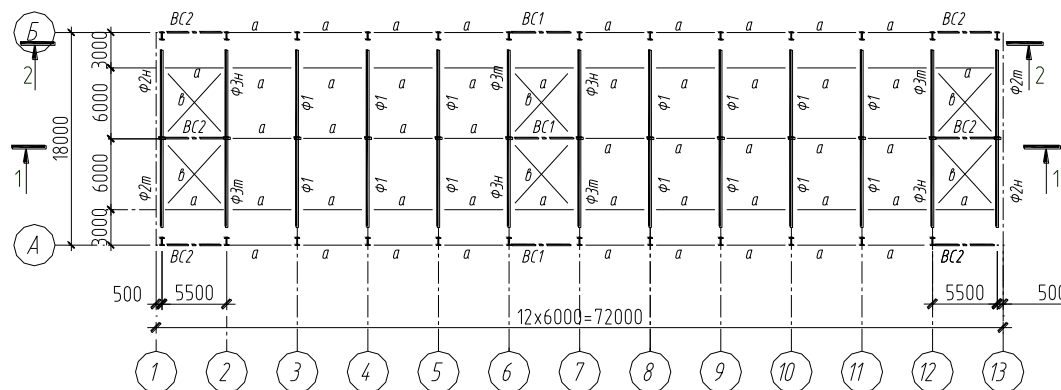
Схема расположения связей по нижним поясам ферм.
